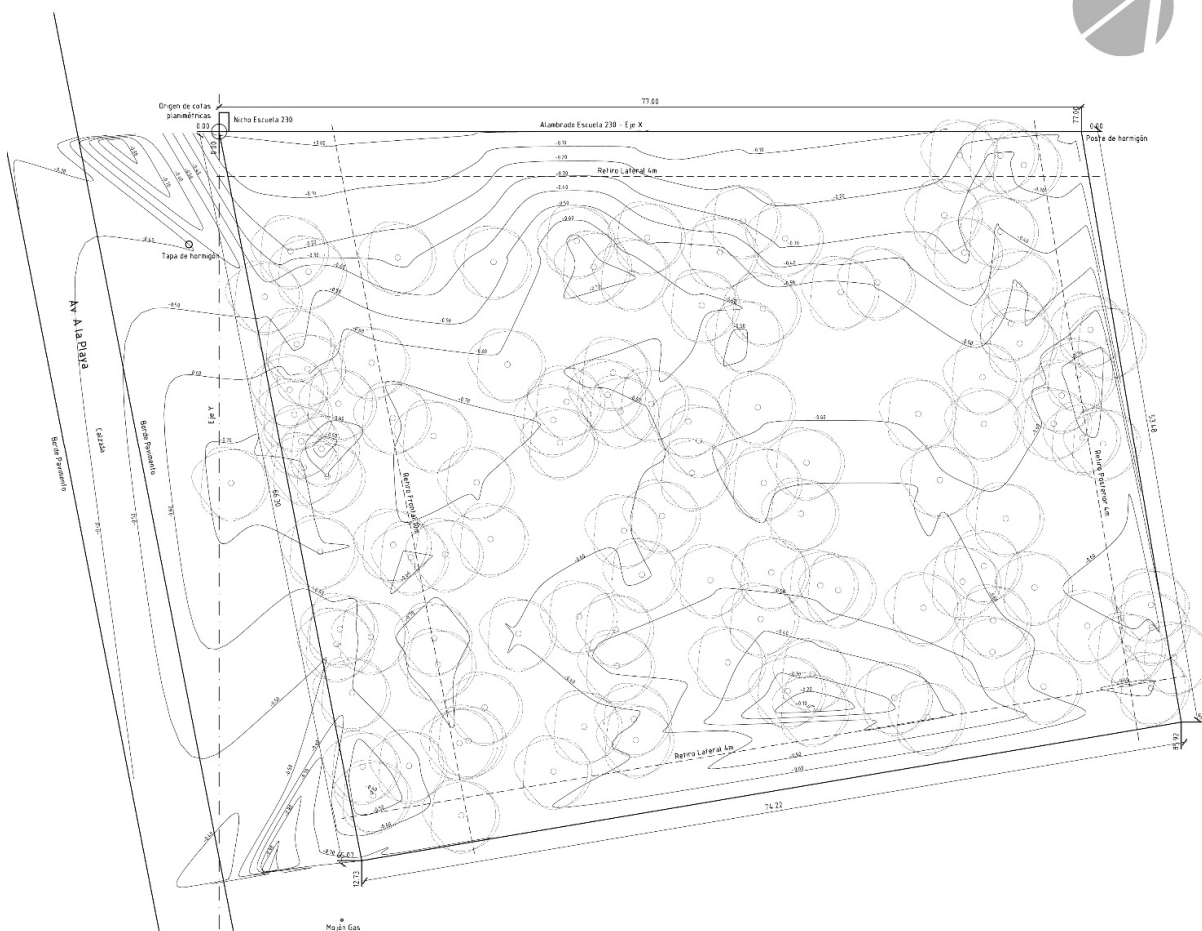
, planta, relevamiento plan-altimétrico realizado por la ANEP en marzo 2021
